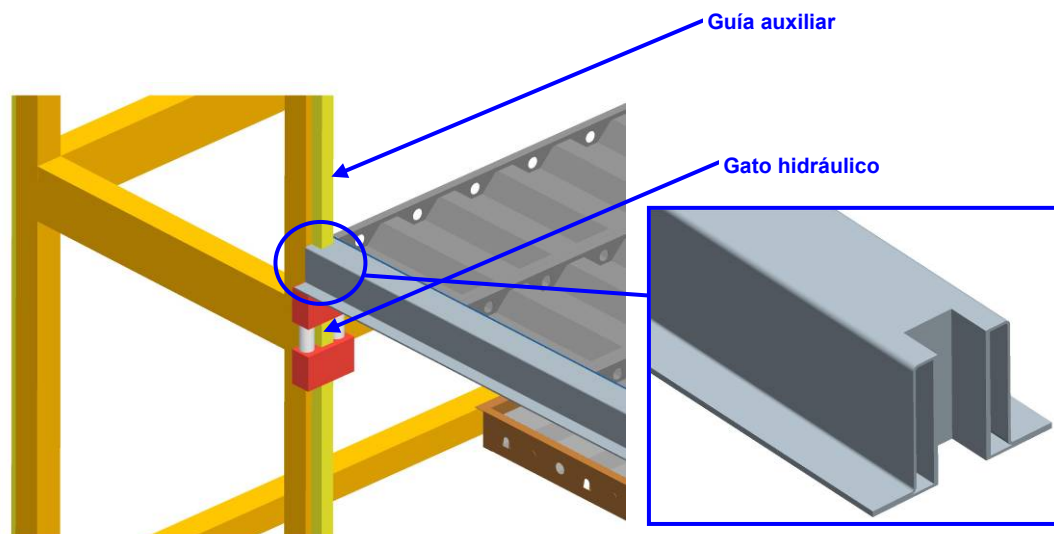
Guiado de la planta y detalle del extremo de la viga
